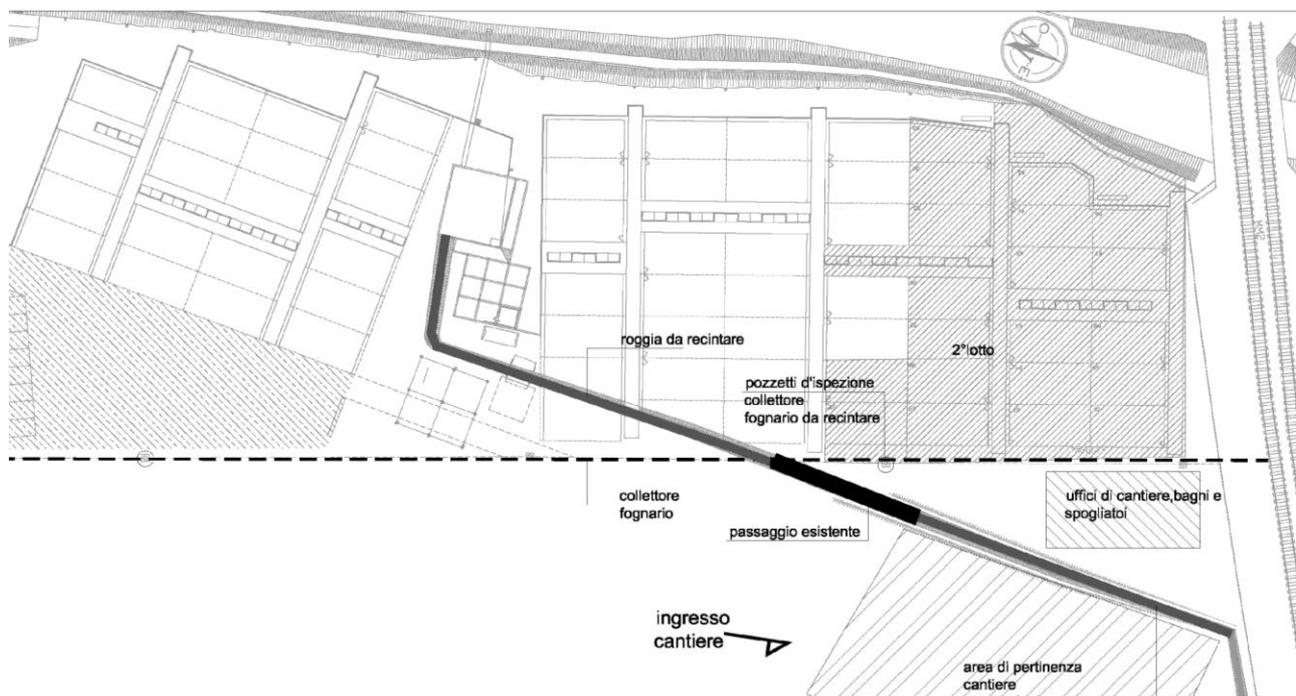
planimetria dell'area di progetto, con gli interventi previsti
